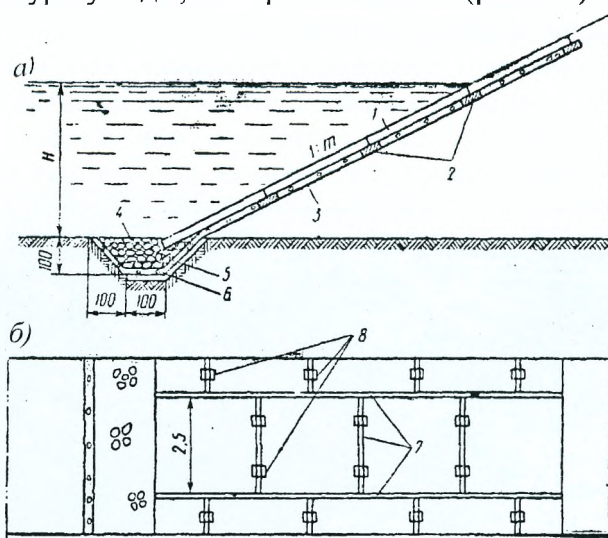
Укрепление откоса насыпи сборными железобетонными плитами, омоноличенными по контуру: а – разрез; б – план; 1 – сборные плиты; 2 – подкладки; 3 – щебеночная или гравийная подготовка; 4 – каменная призма; 5 – крупный песок толщиной слоя 10 см; 6 – щебень или гравий толщиной слоя 15 см; 7 – омоноличенные швы; 8 – закладные части для омоноличивания
